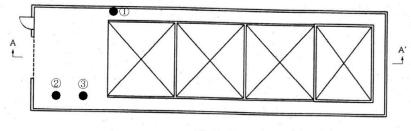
廃液貯留施設 I 平面図及び可燃物配置
